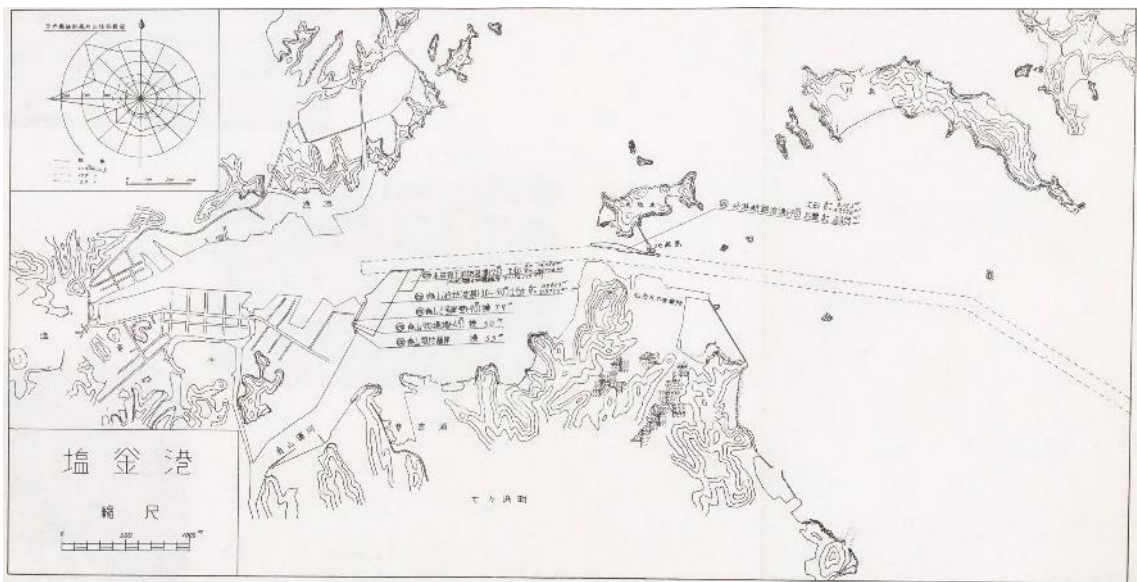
塩釜港工事平面図 (1964年) [541, p. 17]
